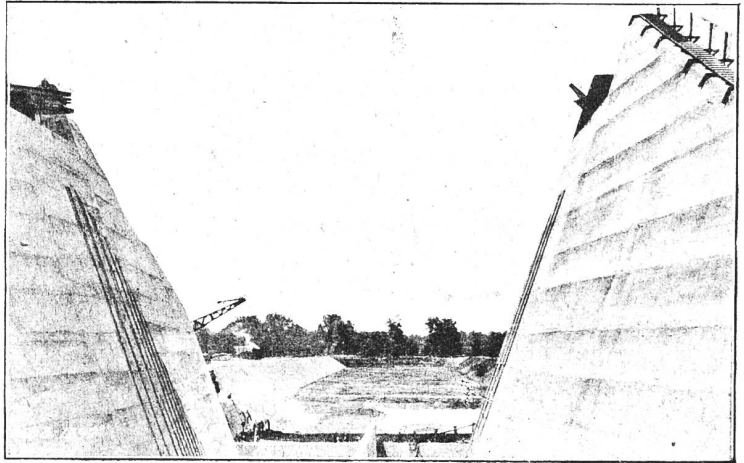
a) und b). Durchlassbauwerk des Lockington-Dammes. Am 11. Juni 1919. Überfallwehr noch nicht betoniert.
